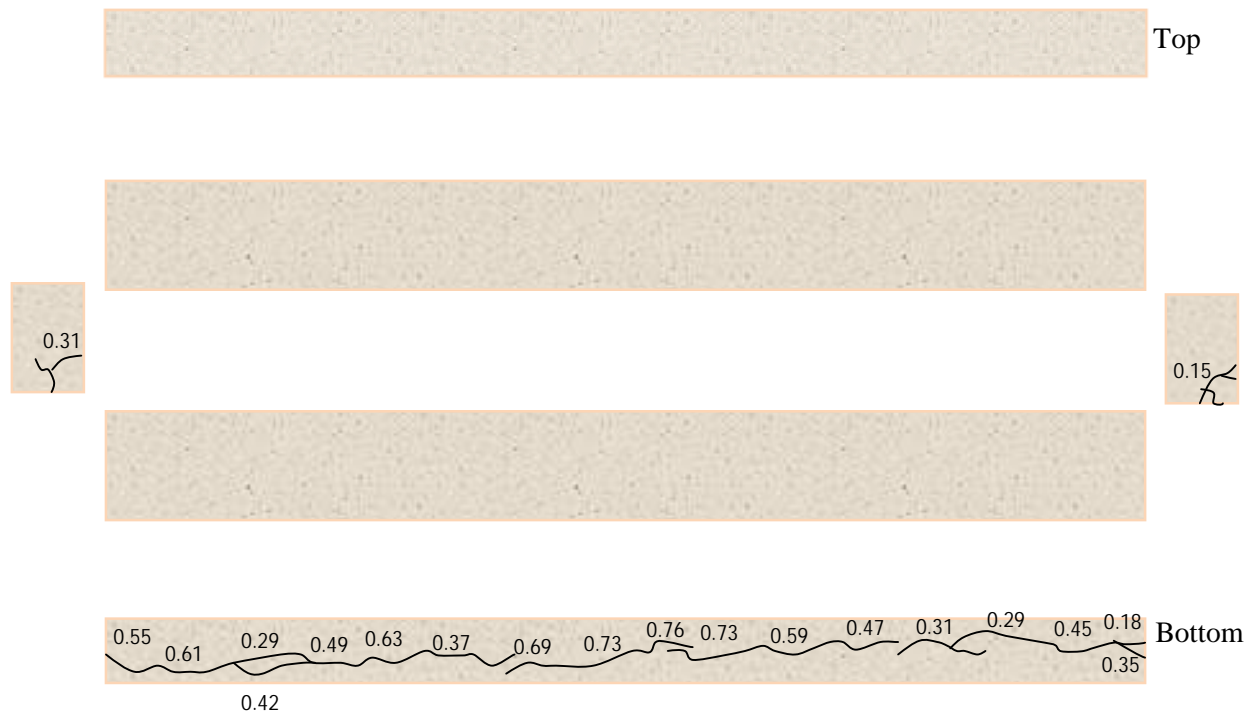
Carte de fissuration de la poutre (séries 2 - 1T16 à 20 kN) avec les ouvertures des fissures de corrosion en mm.
